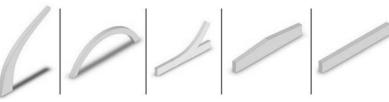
Différentes formes de poutres lamellé-collé [Goubie et Söderlind : 2012]
